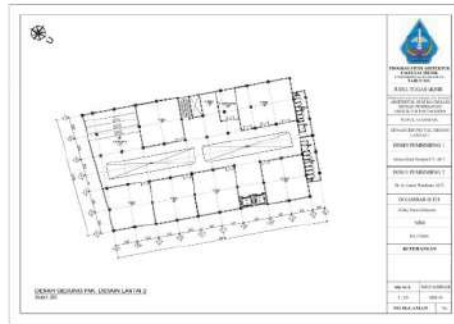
Denah Gedung Penunjang Lantai 2
